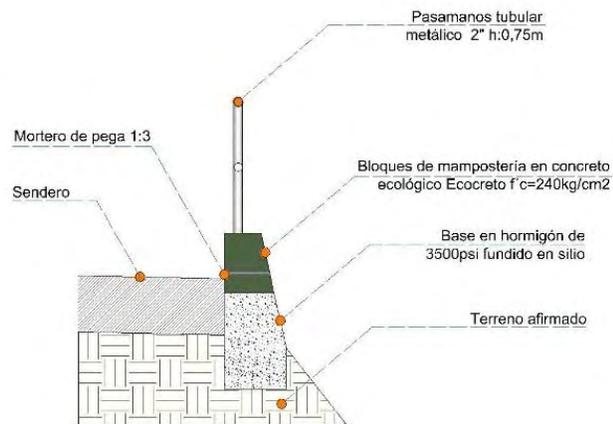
Detalle Confinamiento, Senderos y Balcón.
